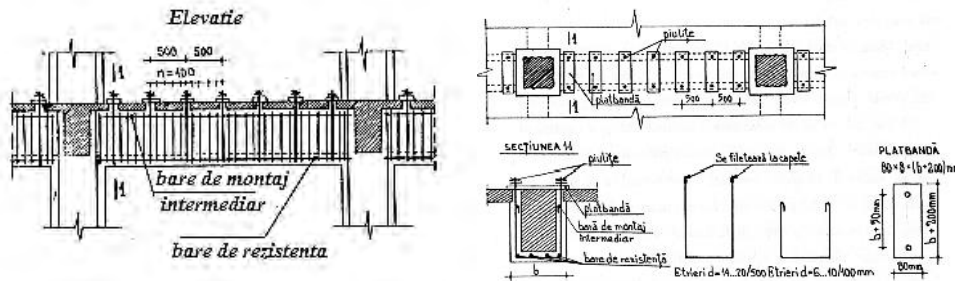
Consolidarea grinzilor de beton armat cu cămășuială pe trei laturi [66]
